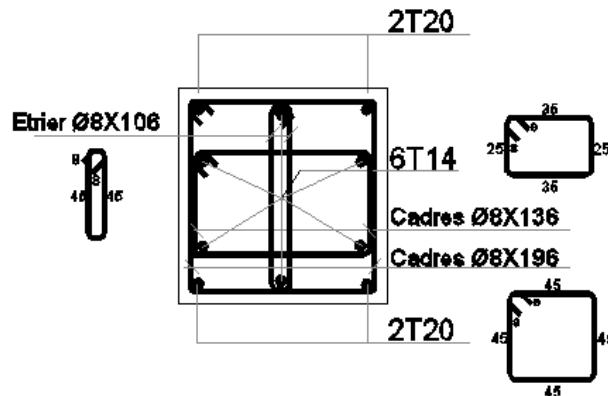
Schéma du ferrailage du poteau 50x50
